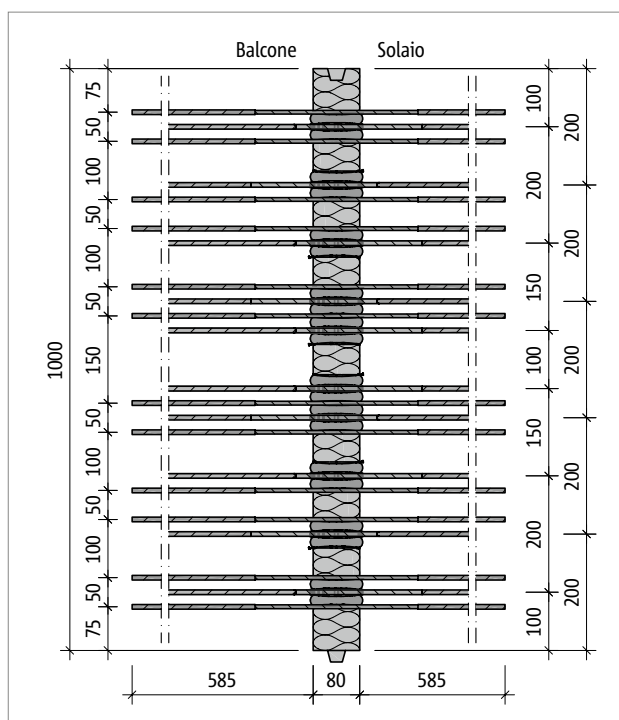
Schöck Isokorb® T tipo KL-M4-VV1: pianta del prodotto
